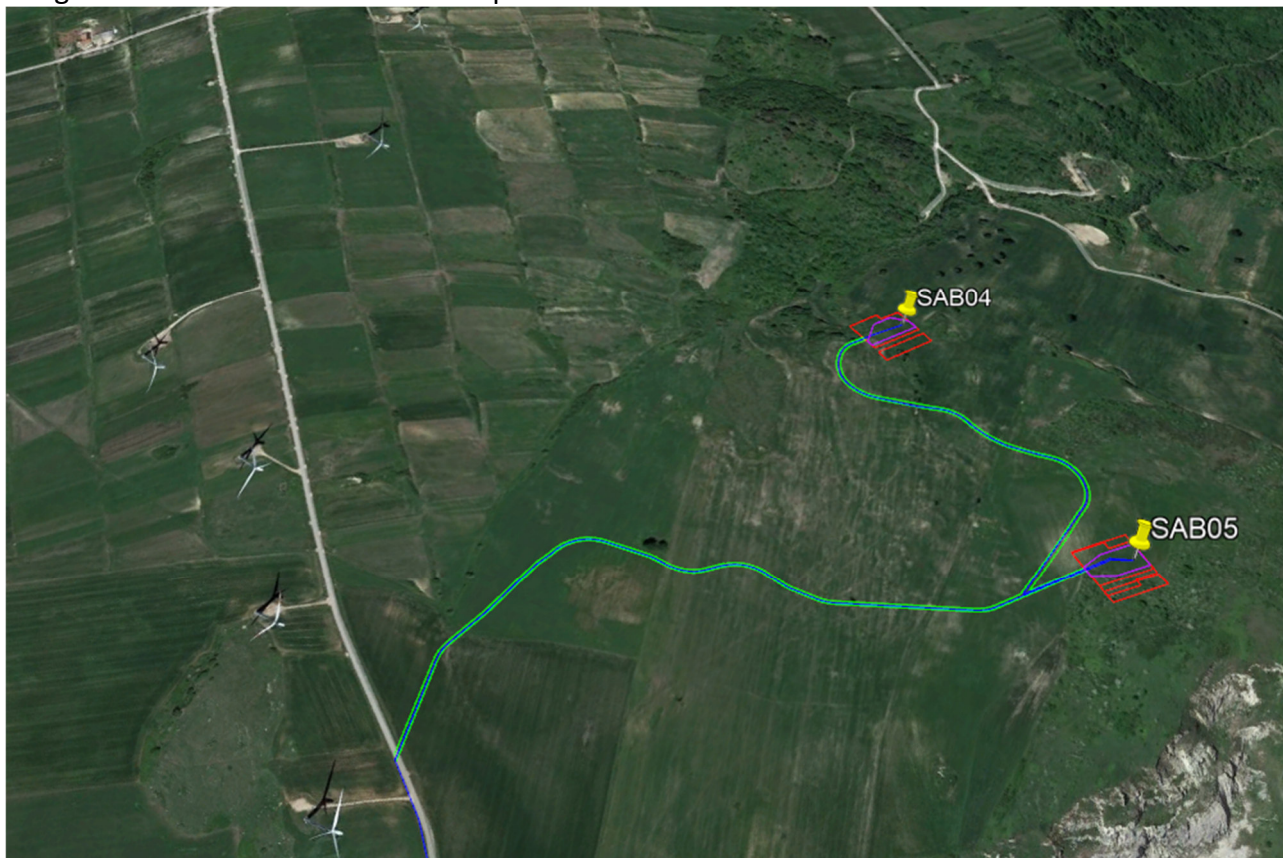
Individuazione dell'innesto della Strada di accesso alla SAB04 e SAB05
